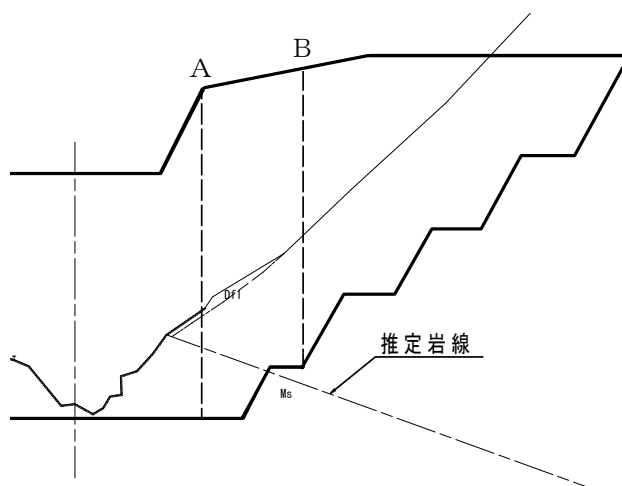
不透過型砂防堰堤 非越流部の設計外力図
